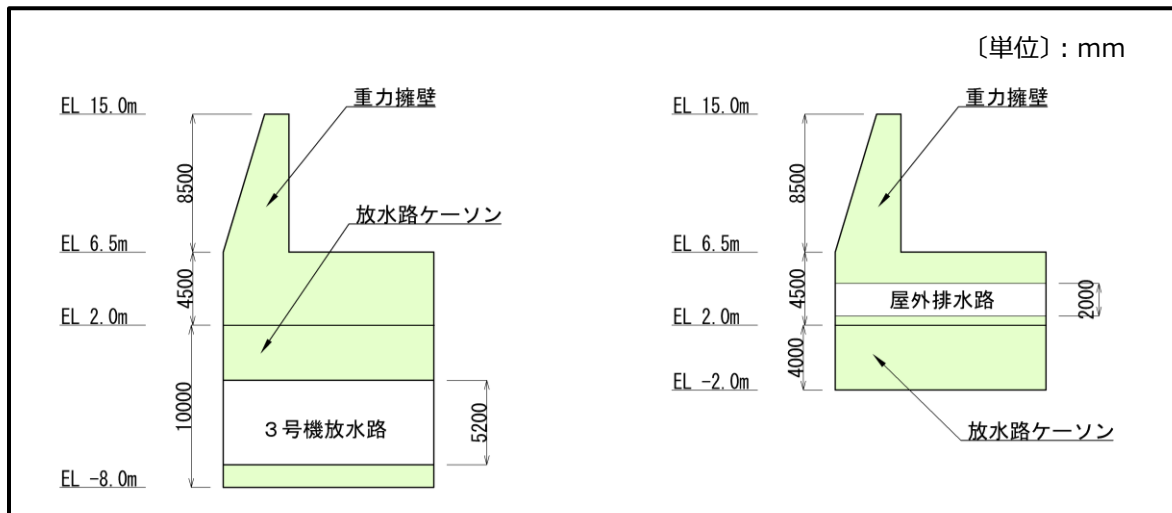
(2) 屋外排水路逆止弁①と接続する屋外排水路と放水路ケーソンの断面図
